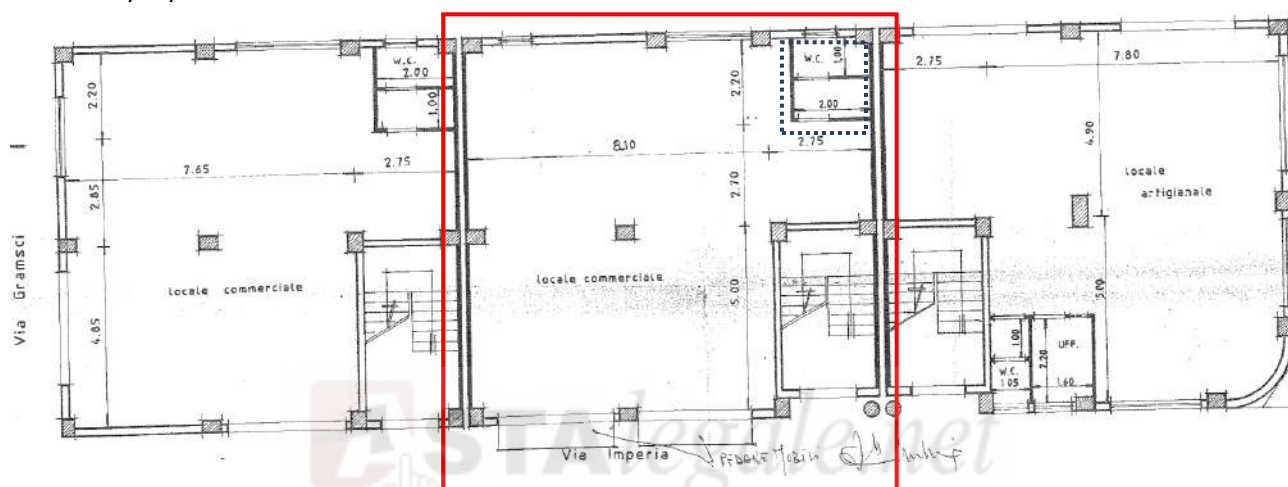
Lotto 2: Planimetria del progetto approvato, con indicata in blu la difformità rilevata
